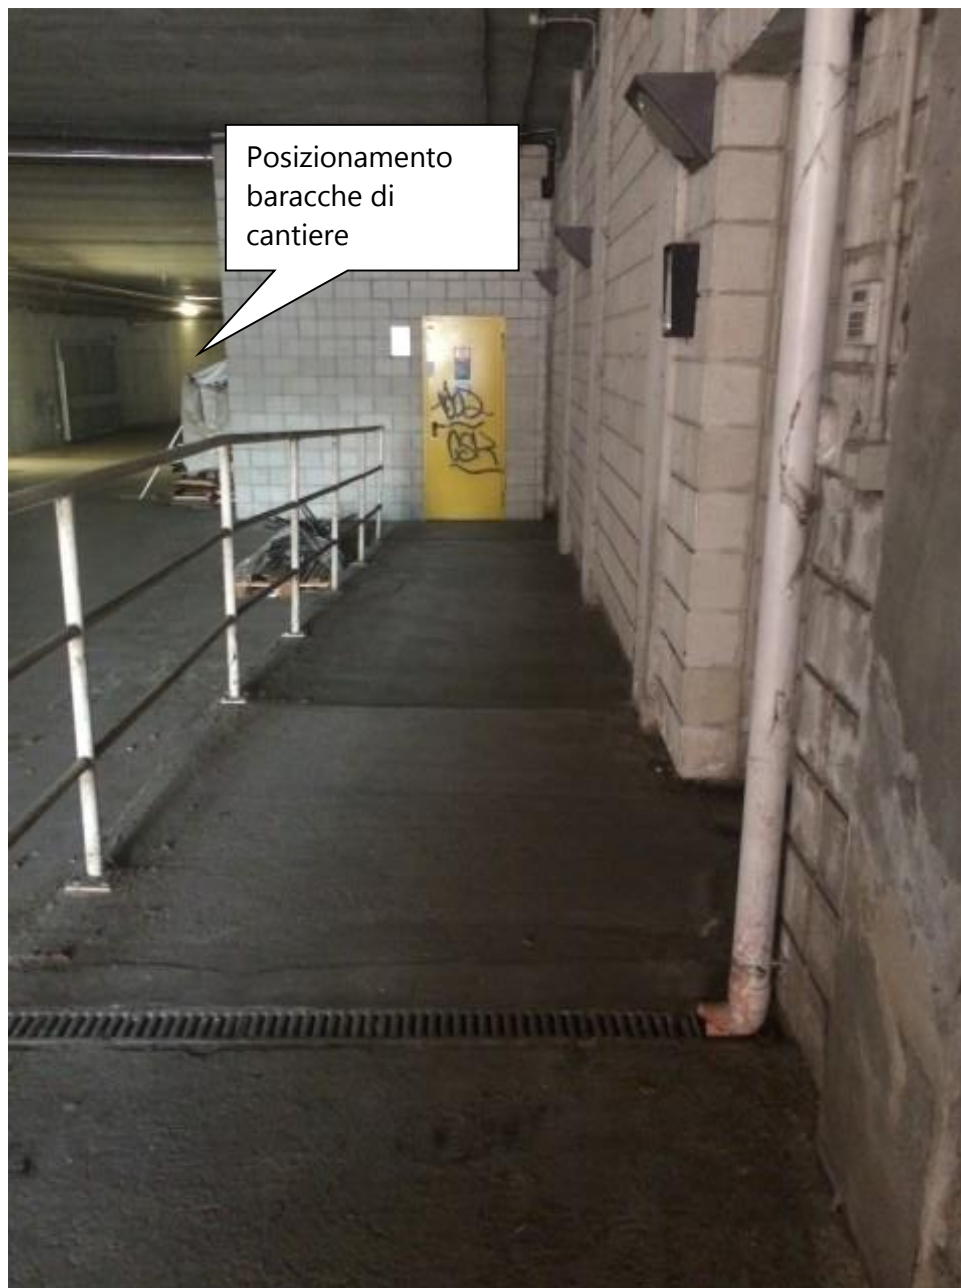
Rampa dall'interno dei locali Pista 2 (servizi igienici a quota -4.13m) alla zona della baracche di cantiere nel tunnel interrato (quota -4.70m).
